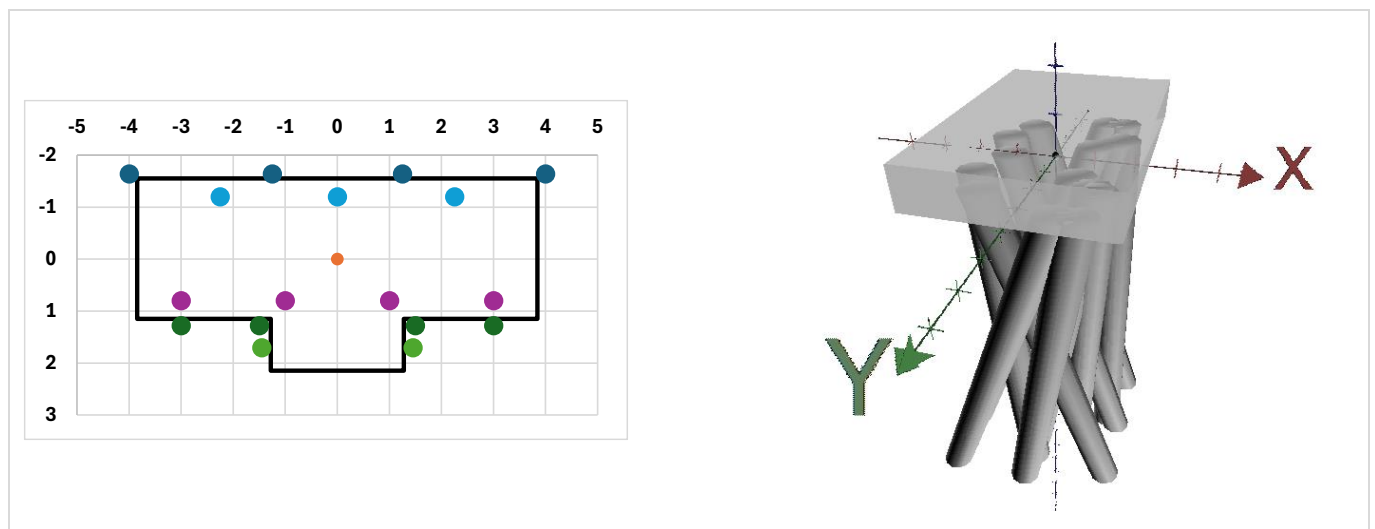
Calepinage des colonnes de jet grouting et modèle de la semelle de la fondation A (Galerie Dauphine)
